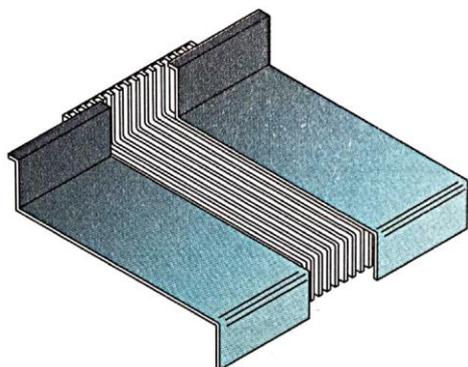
Расширительный стык отлива с подложенным гофрированным профилем
